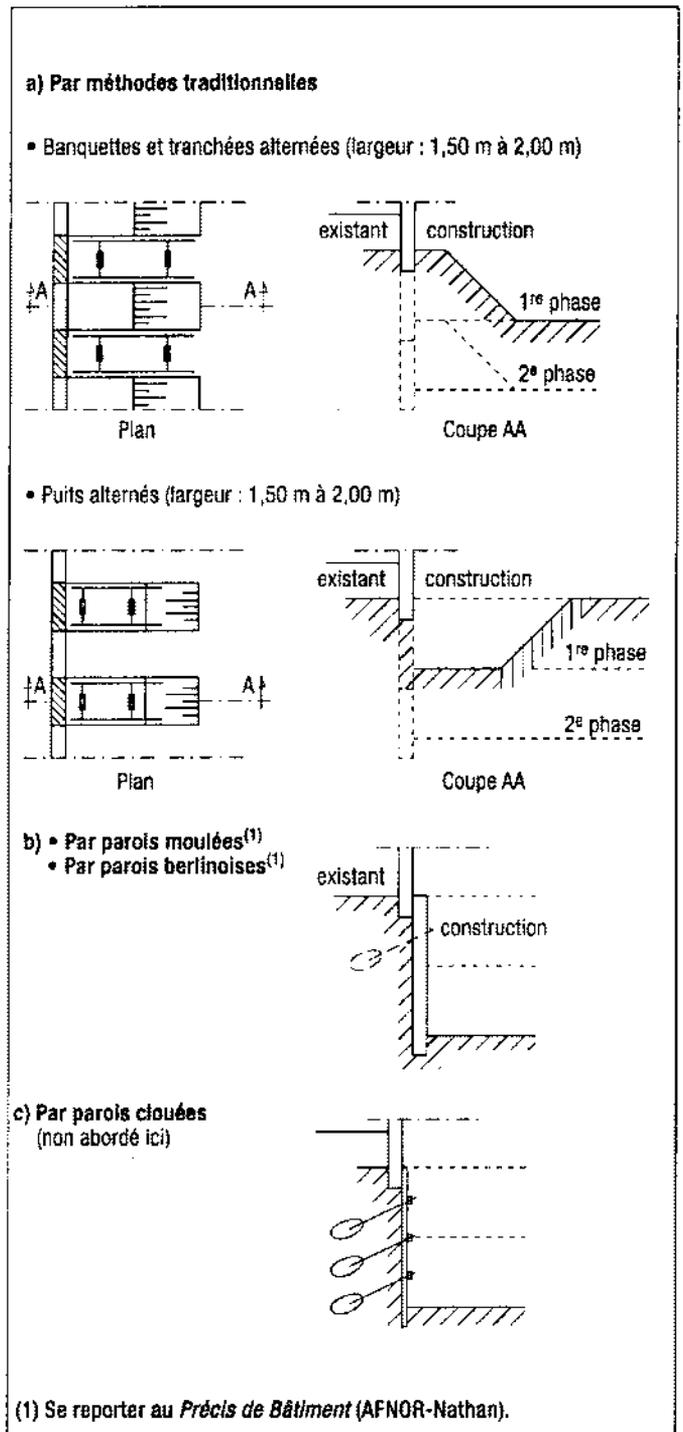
Tenue des parois des fouilles en excavation avec reprise en sous-œuvre éventuelle des constructions voisines.
